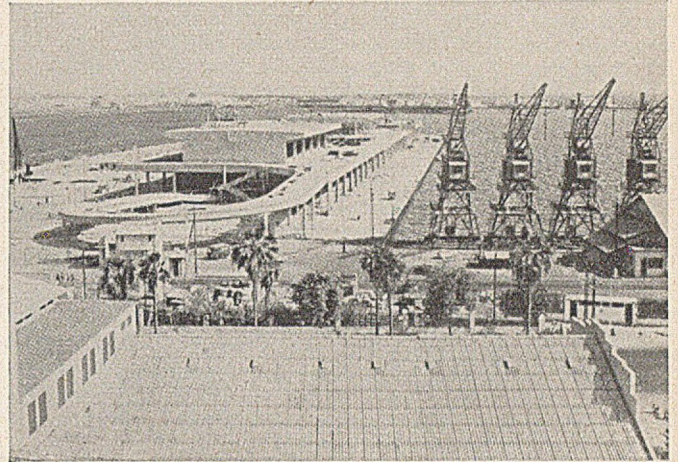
Ostkai mit den im Bau befindlichen Schuppen.
